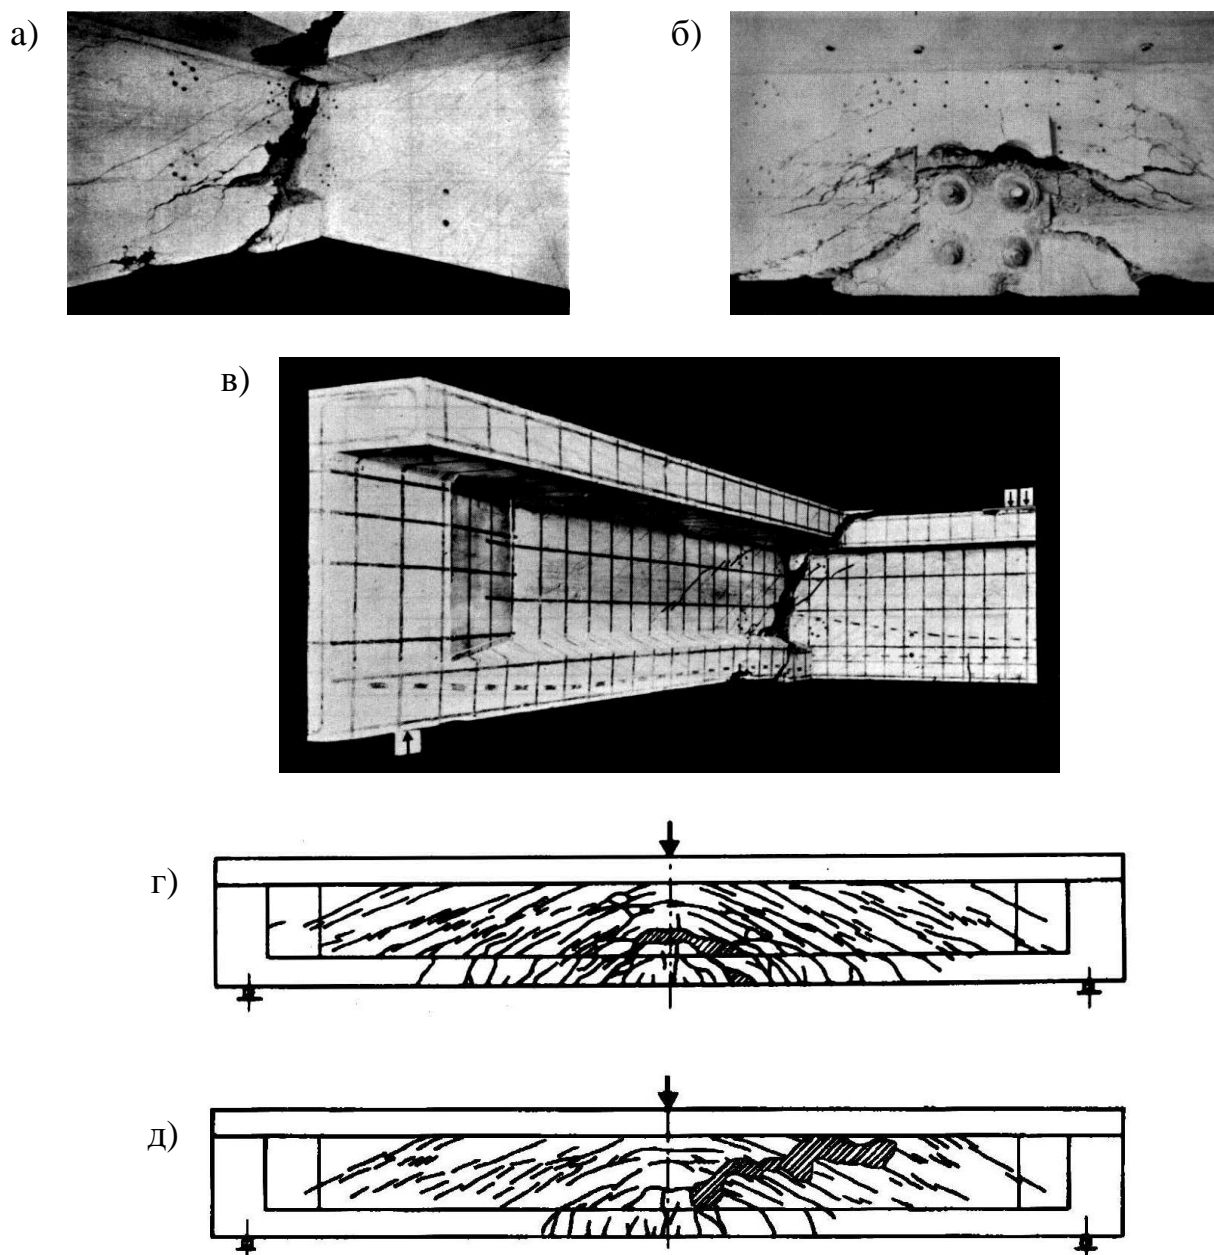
Схемы разрушения и развития трещин в узлах монолитного сопряжения продольных и поперечной балок:
